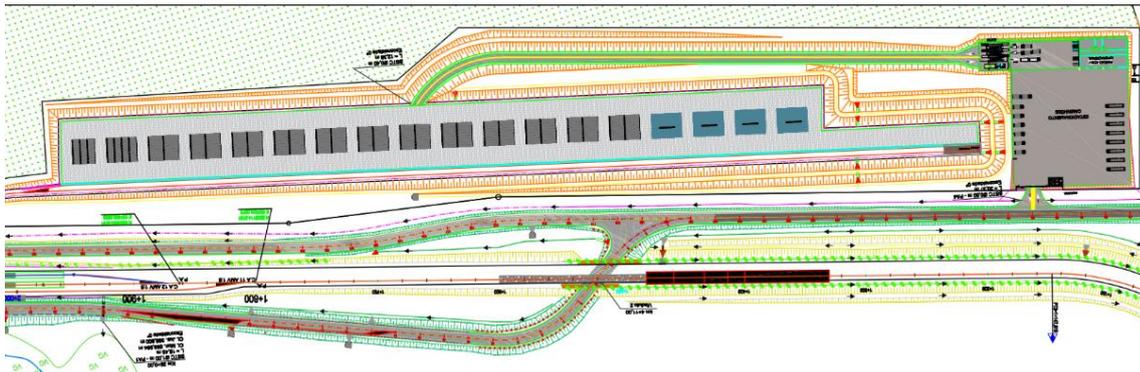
Layout Geral do Terminal Intermodal de Contêineres.
